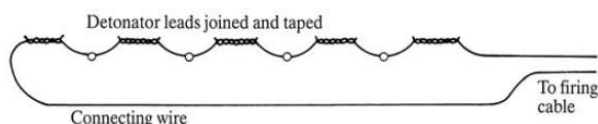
Esquema de uma ligação, de detonadores eléctricos, em série (Rock Excavation Handbook Tamrock, 1999)
